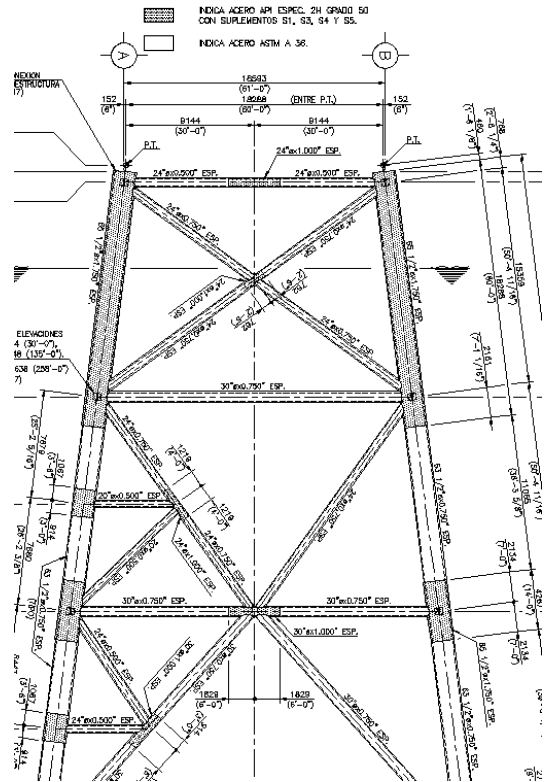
Elevación estructural de una subestructura eje transversal (plano).
